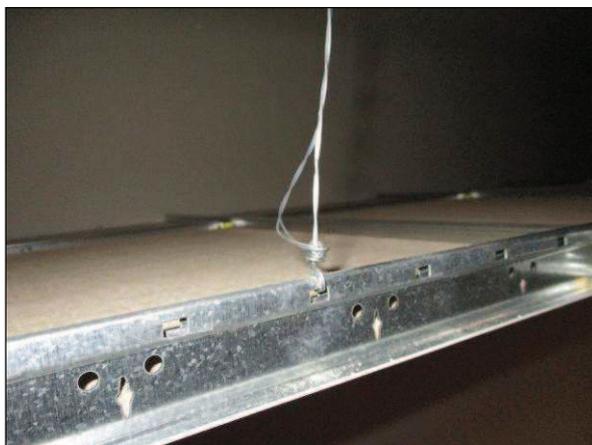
Particolare dell'ancoraggio della struttura di supporto dei pannelli al pendino.
